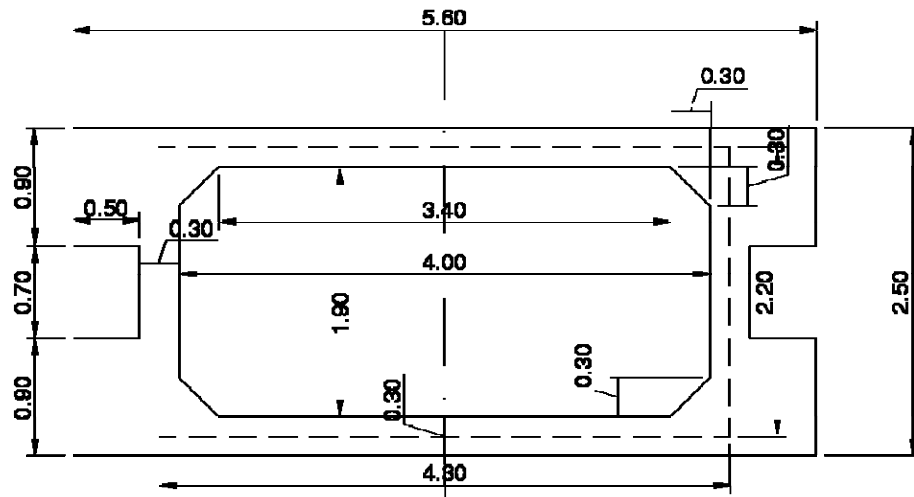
Carpenteria della sezione 1 delle pile;
